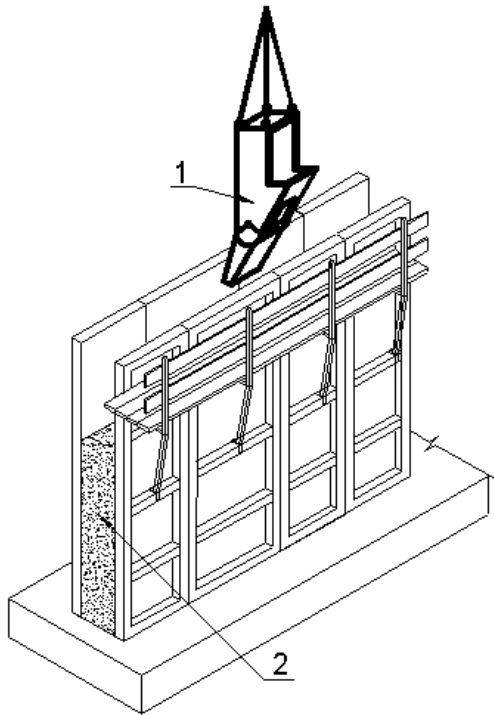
Укладка бетонной смеси в конструкцию по системе «кран-бадья». 1 – бункер с бетонной смесью, 2 – укладываемая бетонная смесь.
